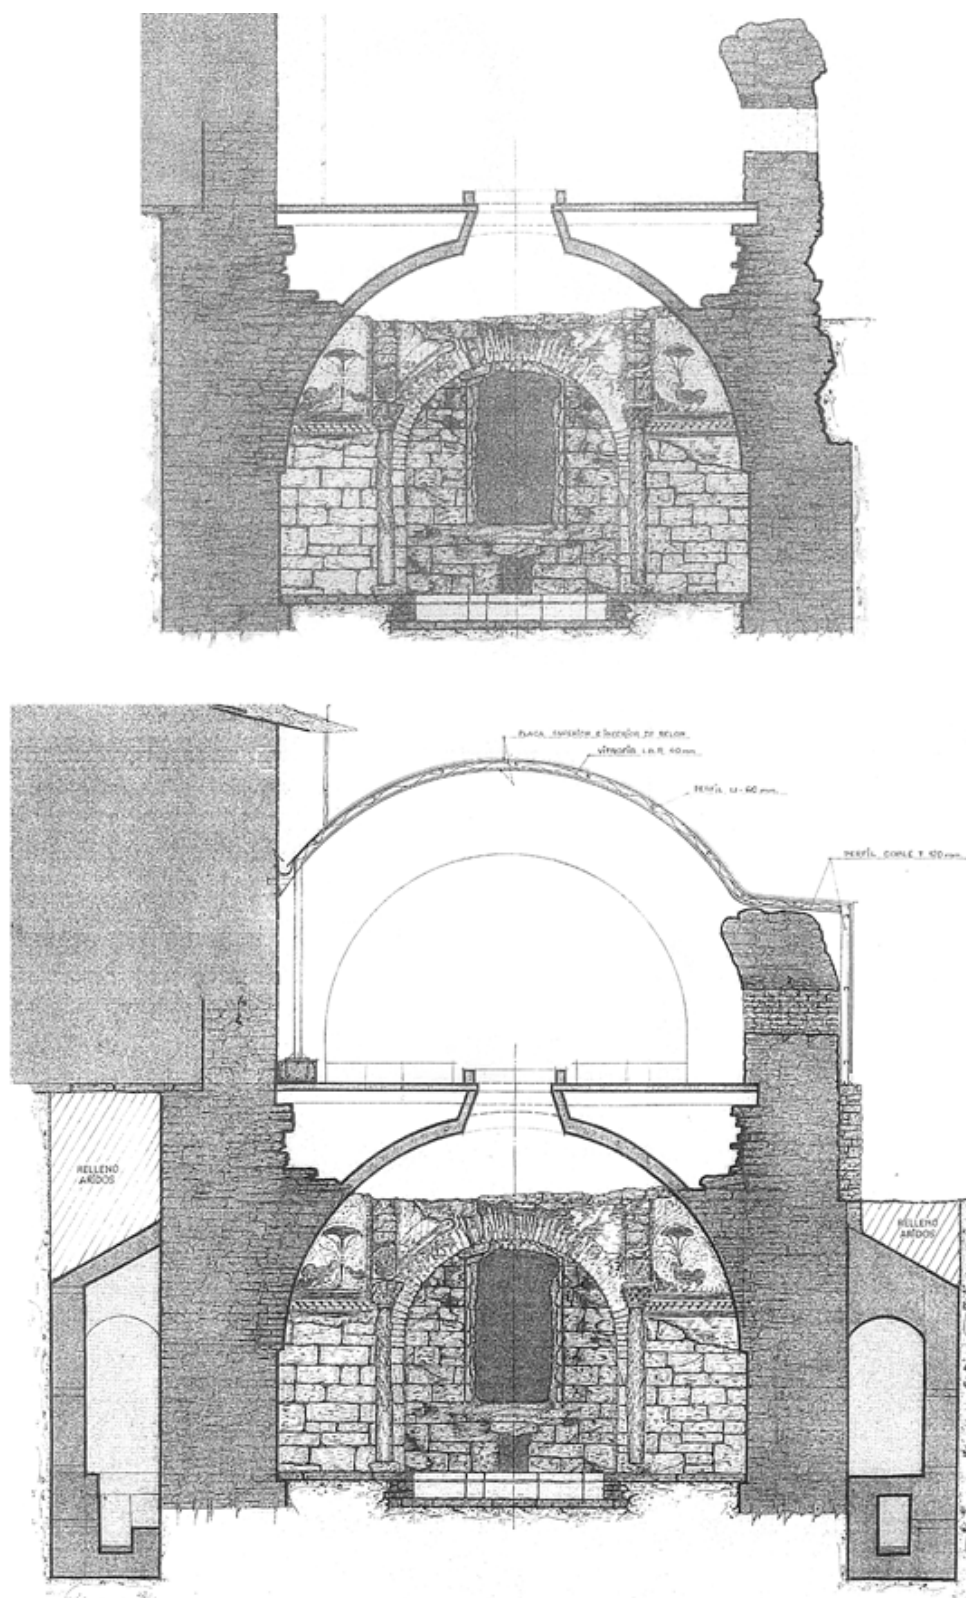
Sección transversal antes y después en el proyecto de la realización de la cubierta en la planta superior
